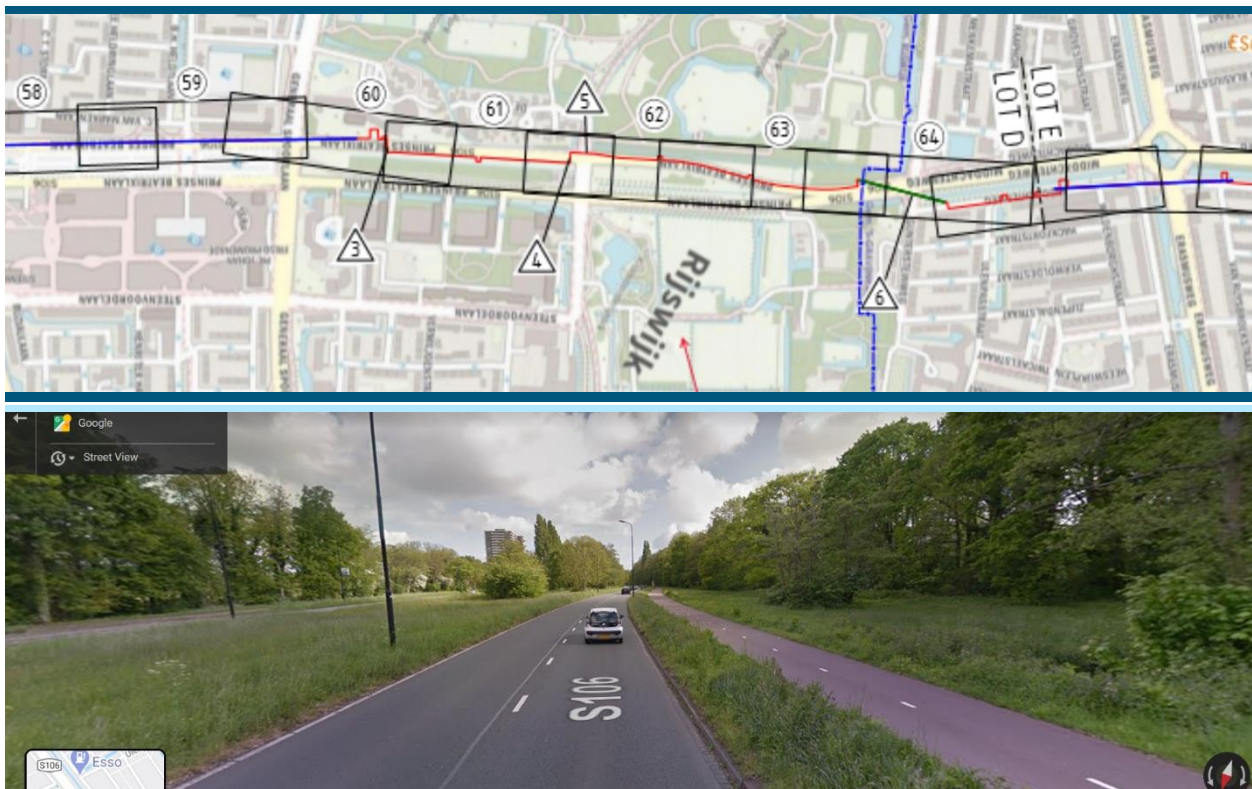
Uitsnede ter hoogte van de overgang van de Kruithuisweg naar de Prinses Beatrixlaan.
